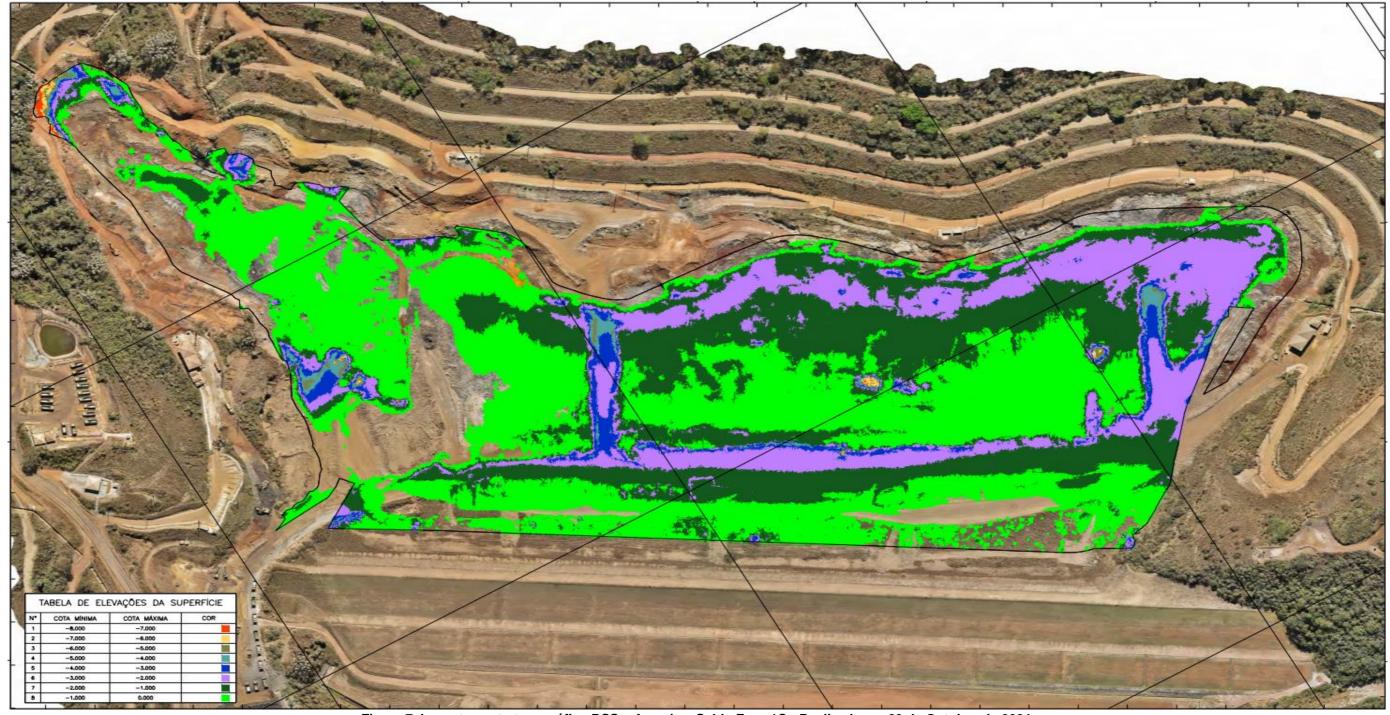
Levantamento topográfico BSS – Arranjo – Saldo Fase 1C - Realizado em 23 de Outubro de 2024.
